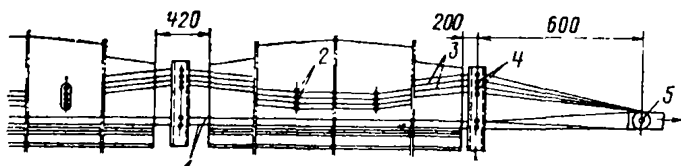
Схема фиксации отогнутой арматуры при изготовлении конструкций на длинном стенде
